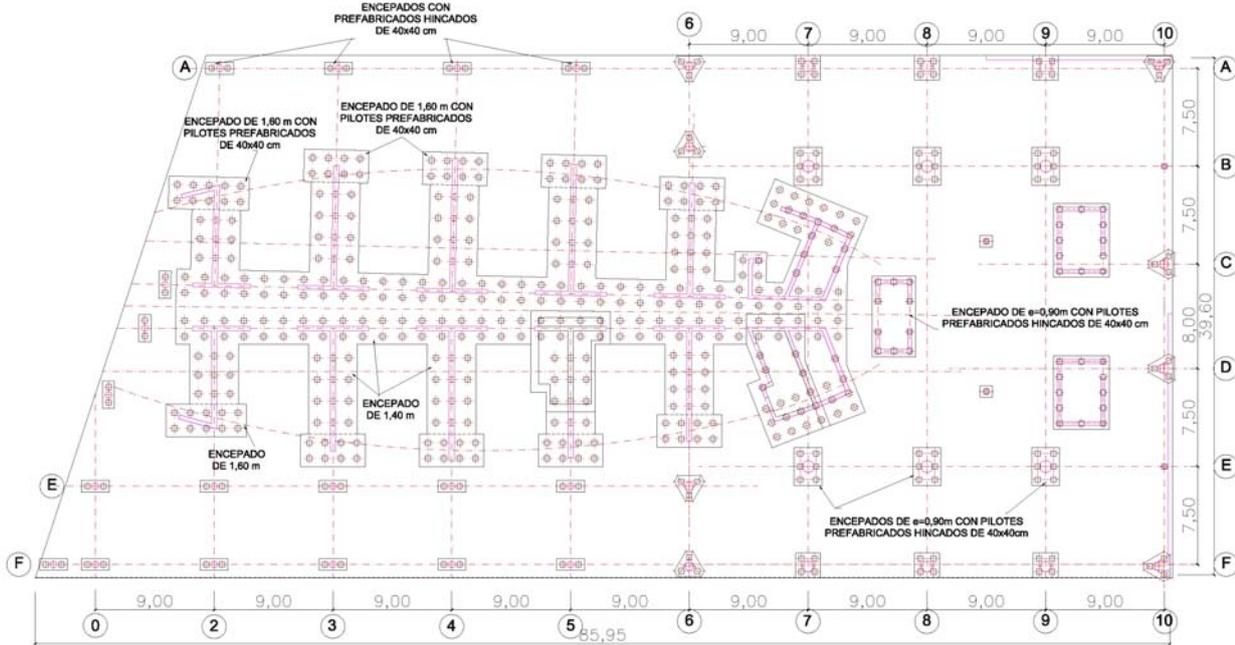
Planta de la cimentación de los edificios Torre y Atrio con pilotes prefabricados hincados
